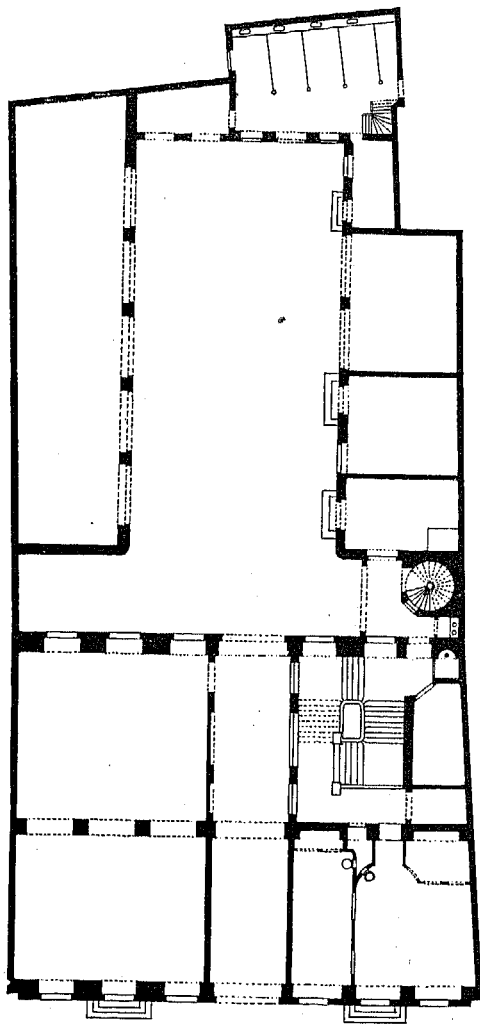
Grosser Korb; Grundriss des Erdgeschosses.
